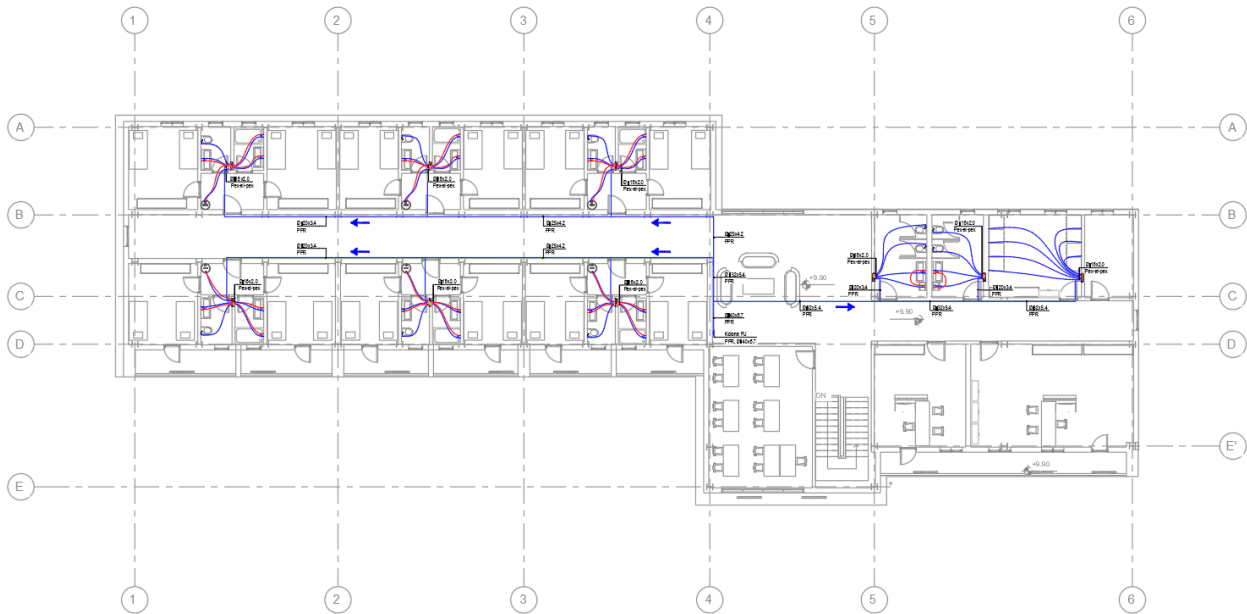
Planimetria e Njjes Sanitare në katin e dytë dhe të tretë
